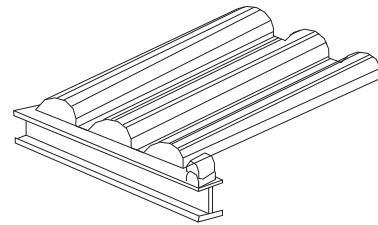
Cubierta (chapa blócatela) sostenida en viga IPR ^{40.2}
